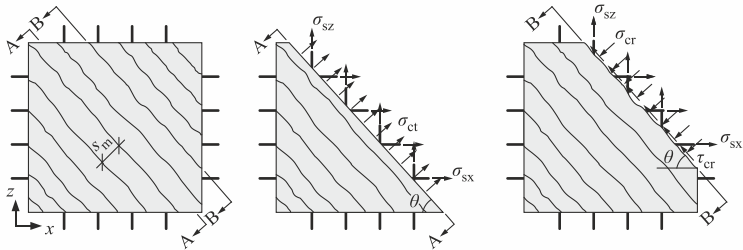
Bewehrte Betonscheibe unter Schubbeanspruchung nach [Col-1996]
